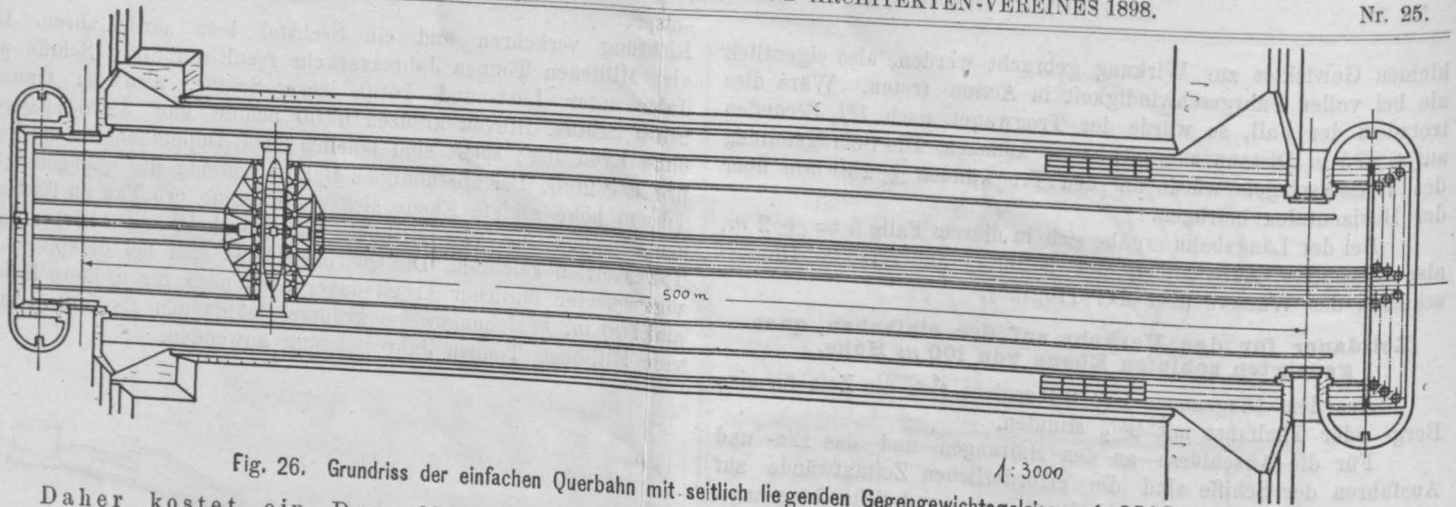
Grundriss der einfachen Querbahn mit seitlich liegenden Gegengewichtsgeleisen. 1:3000.
